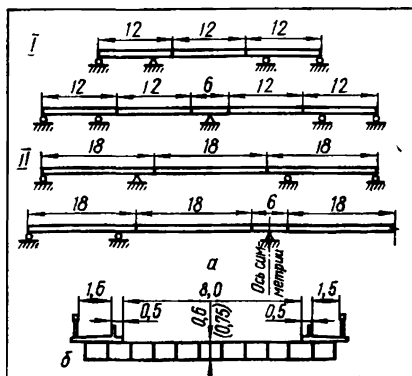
Схемы неразрезных путепроводов из пустотных плит (а) и поперечное сечение путепровода (б):
